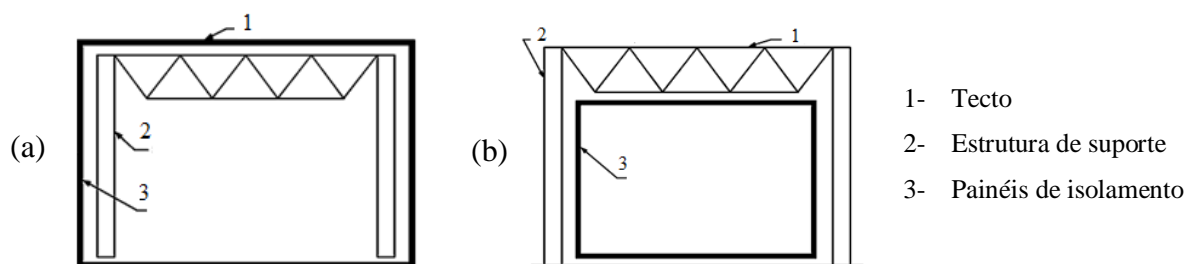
Construção em sistema estrutural interior (a) e estrutural exterior (b).
